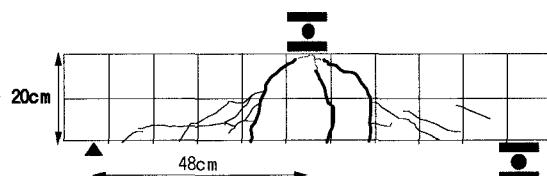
中供試体のひび割れ図（初期欠陥なし）
